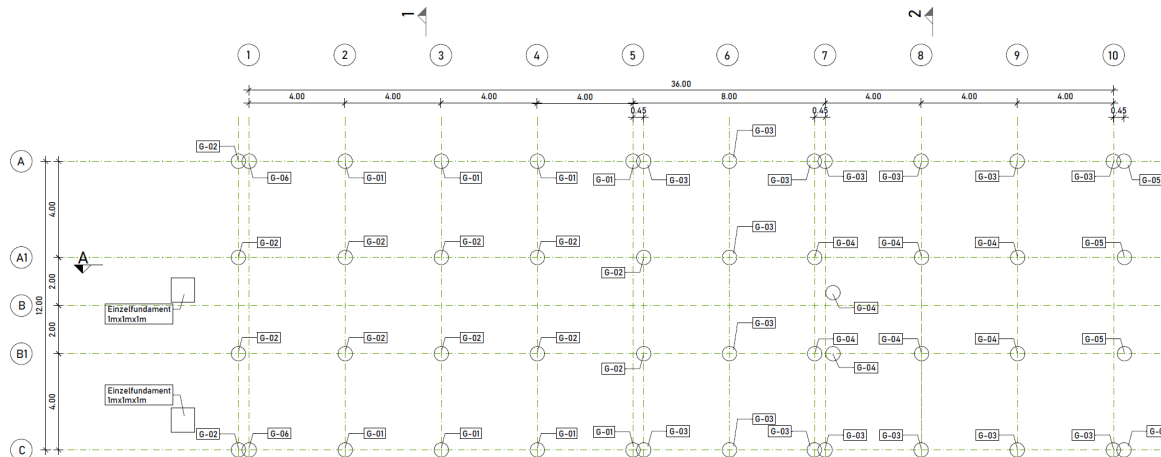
Vorentwurf GRW-Projekt, Grundriss Fundamentanordnung, Stand 04.04.2023
